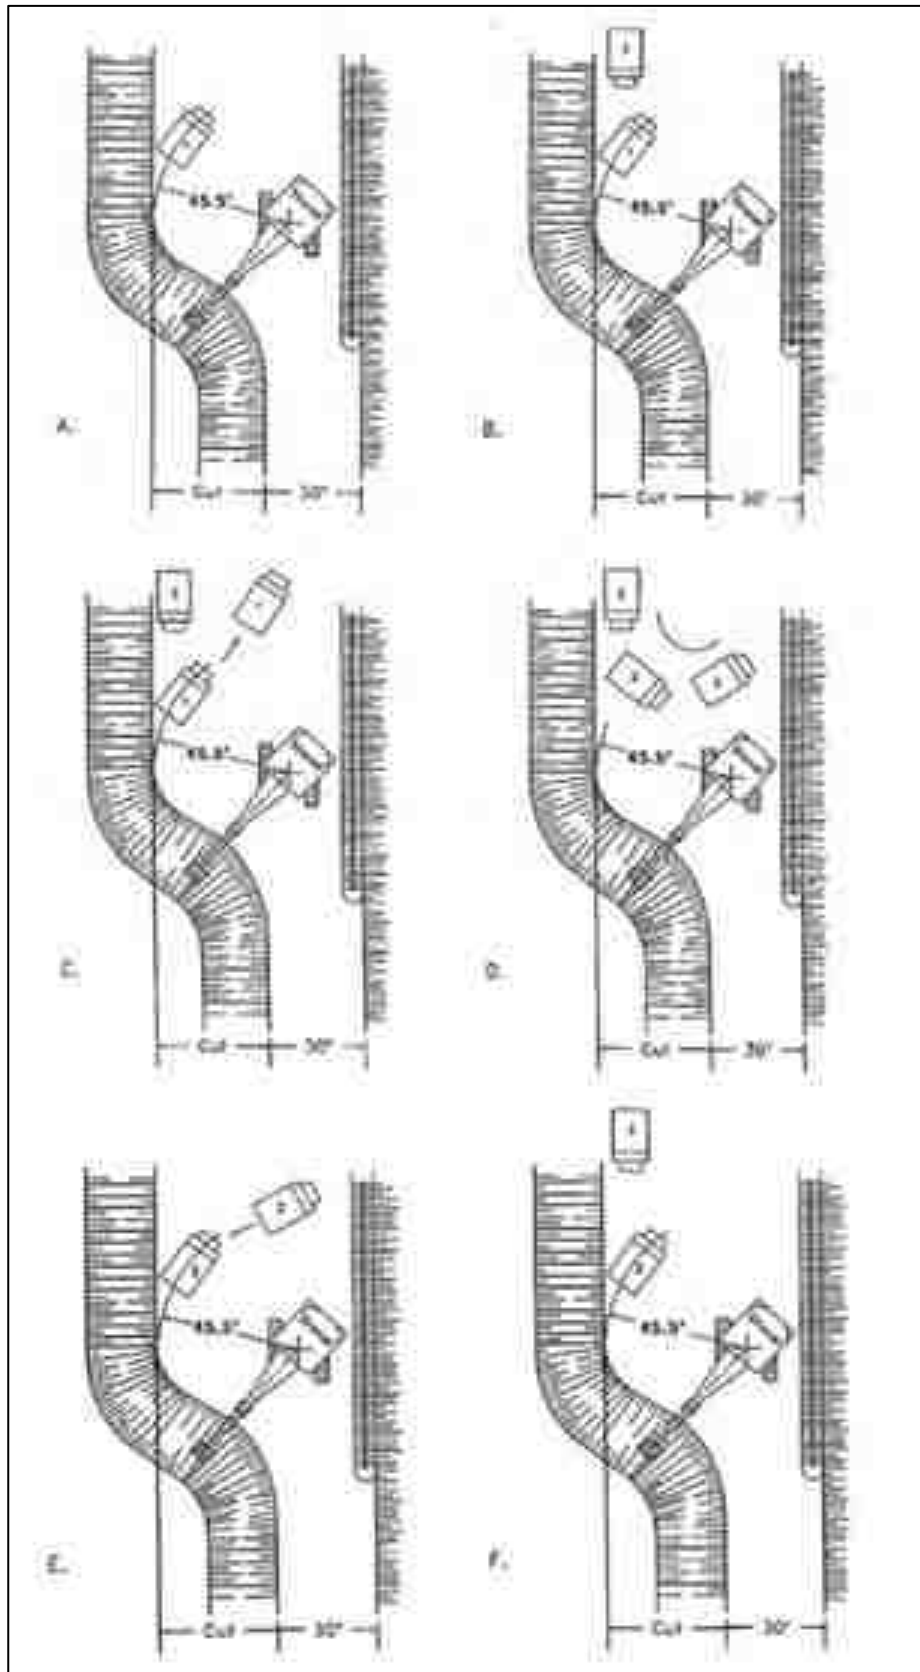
34. Secuencia de minado en corte paralelo a un solo lado
